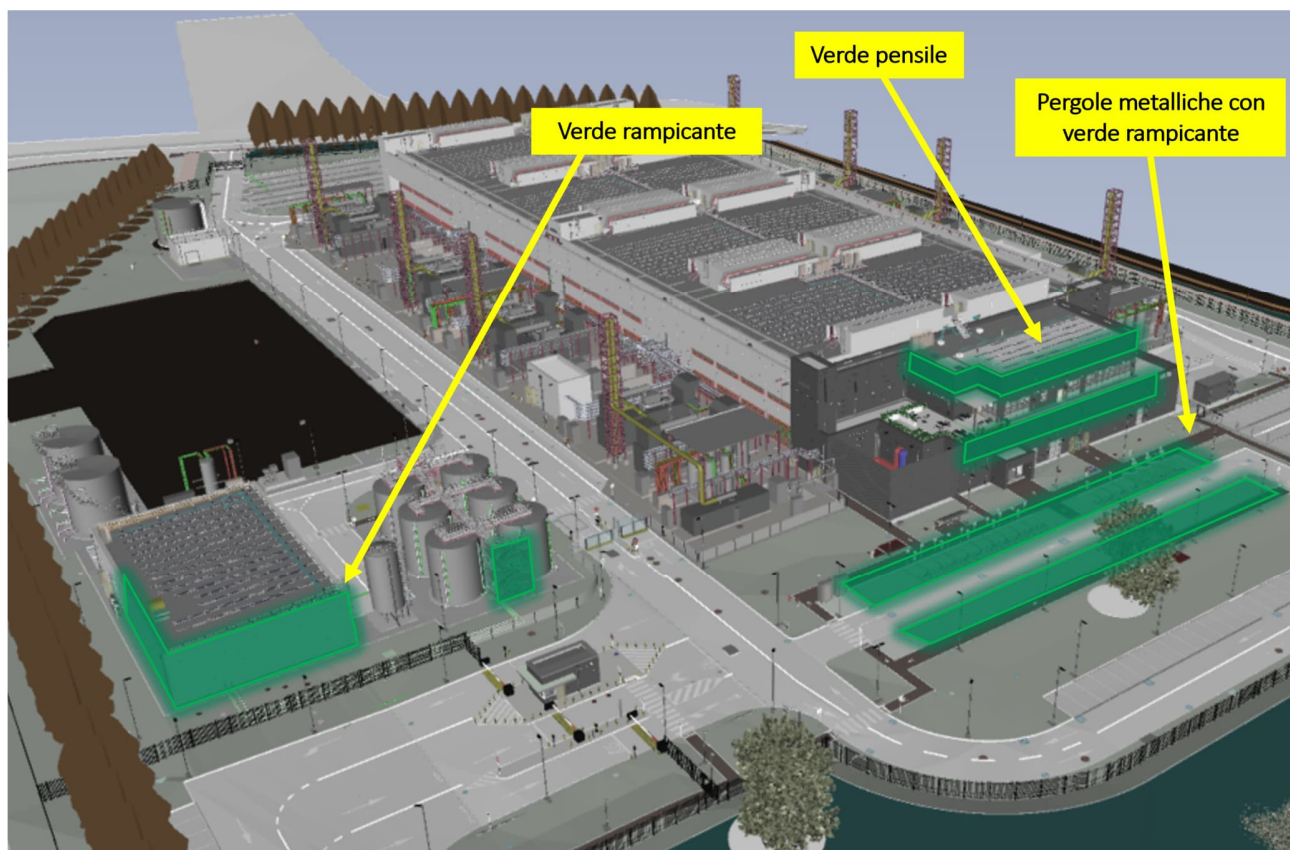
Rendering di impianto con gli interventi a verde verticale previsti – vista lato nord dell'impianto.
